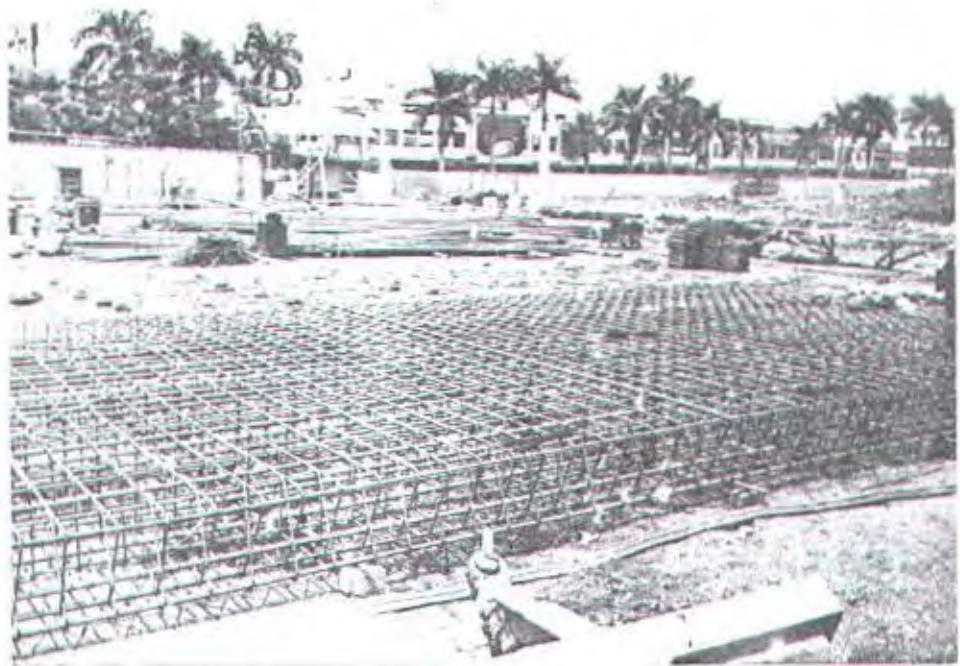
Lokasi penempatan Mixing Plan & Pembesian
